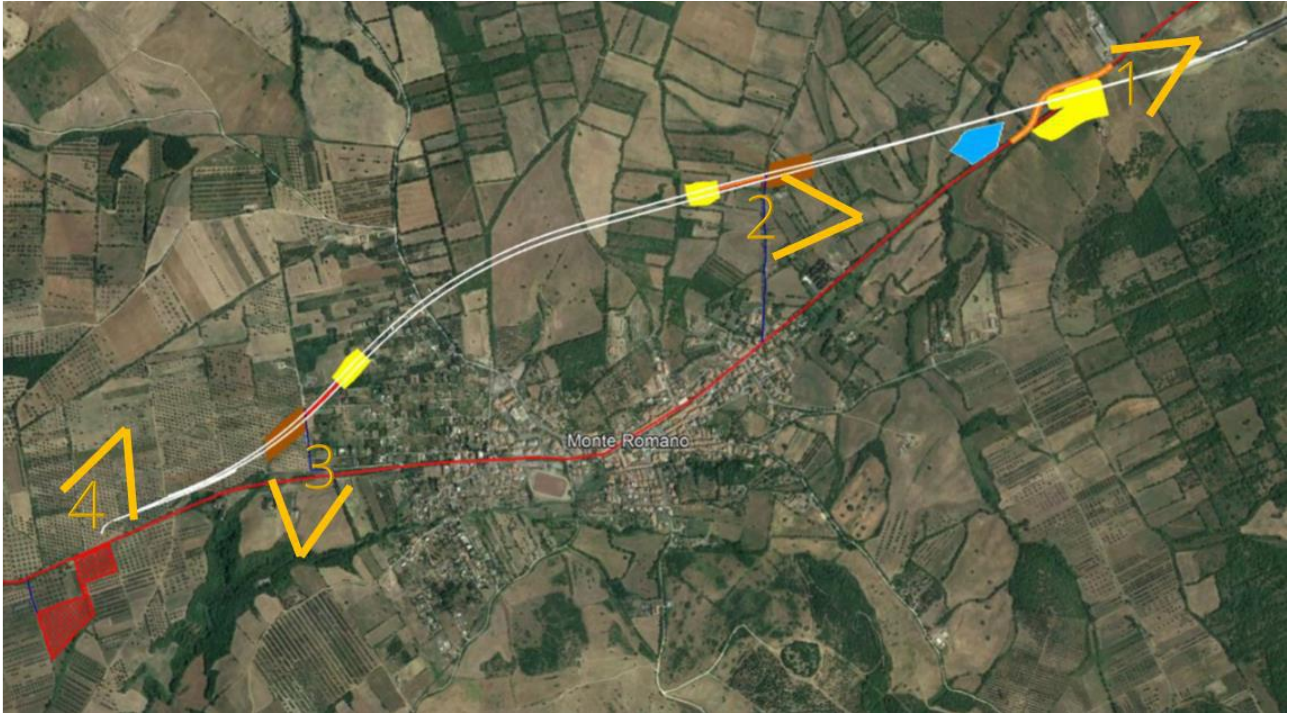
Keyplan delle aree di cantiere e del nuovo tracciato stradale della SS675
